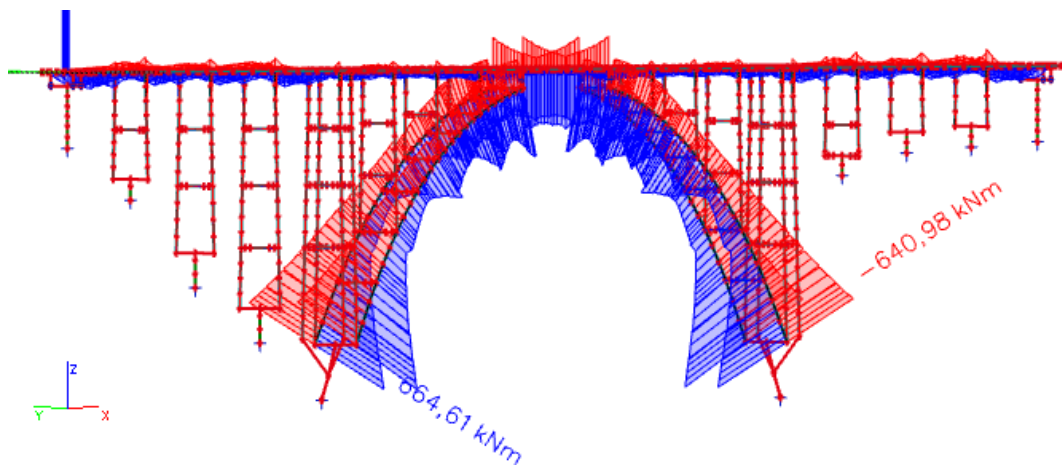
Normální zatížitelnost – umístění dvounáprav na konstrukci – varianta 1
